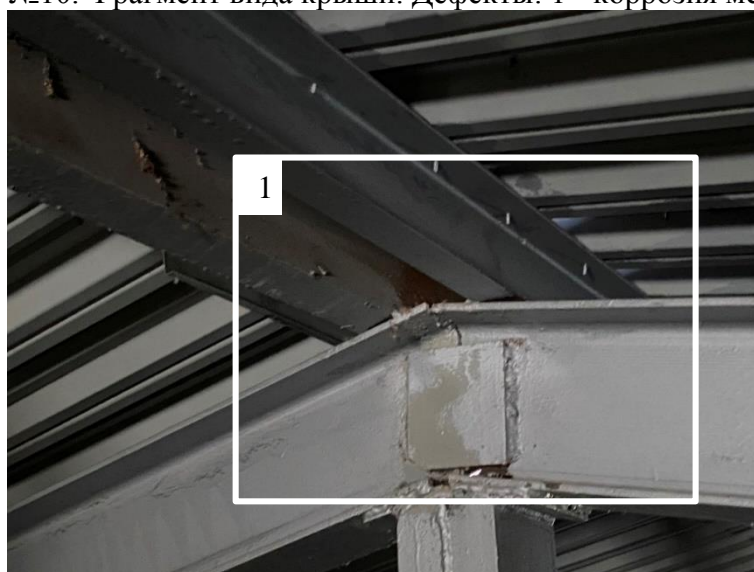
Фрагмент вида крыши. Дефекты: 1 - коррозия металла.
